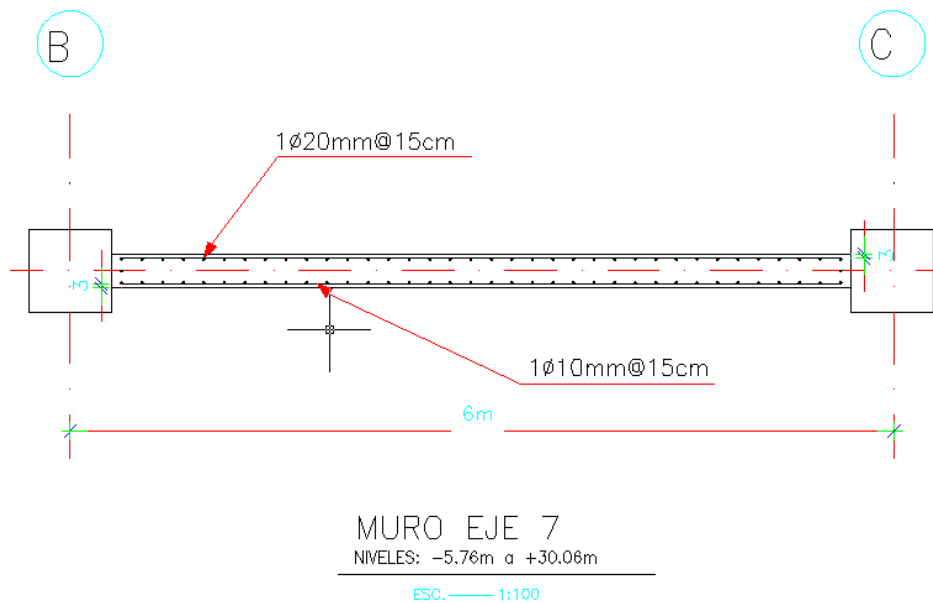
(c) Detalle del armado del muro para pisos bajos del muro en diseño.
